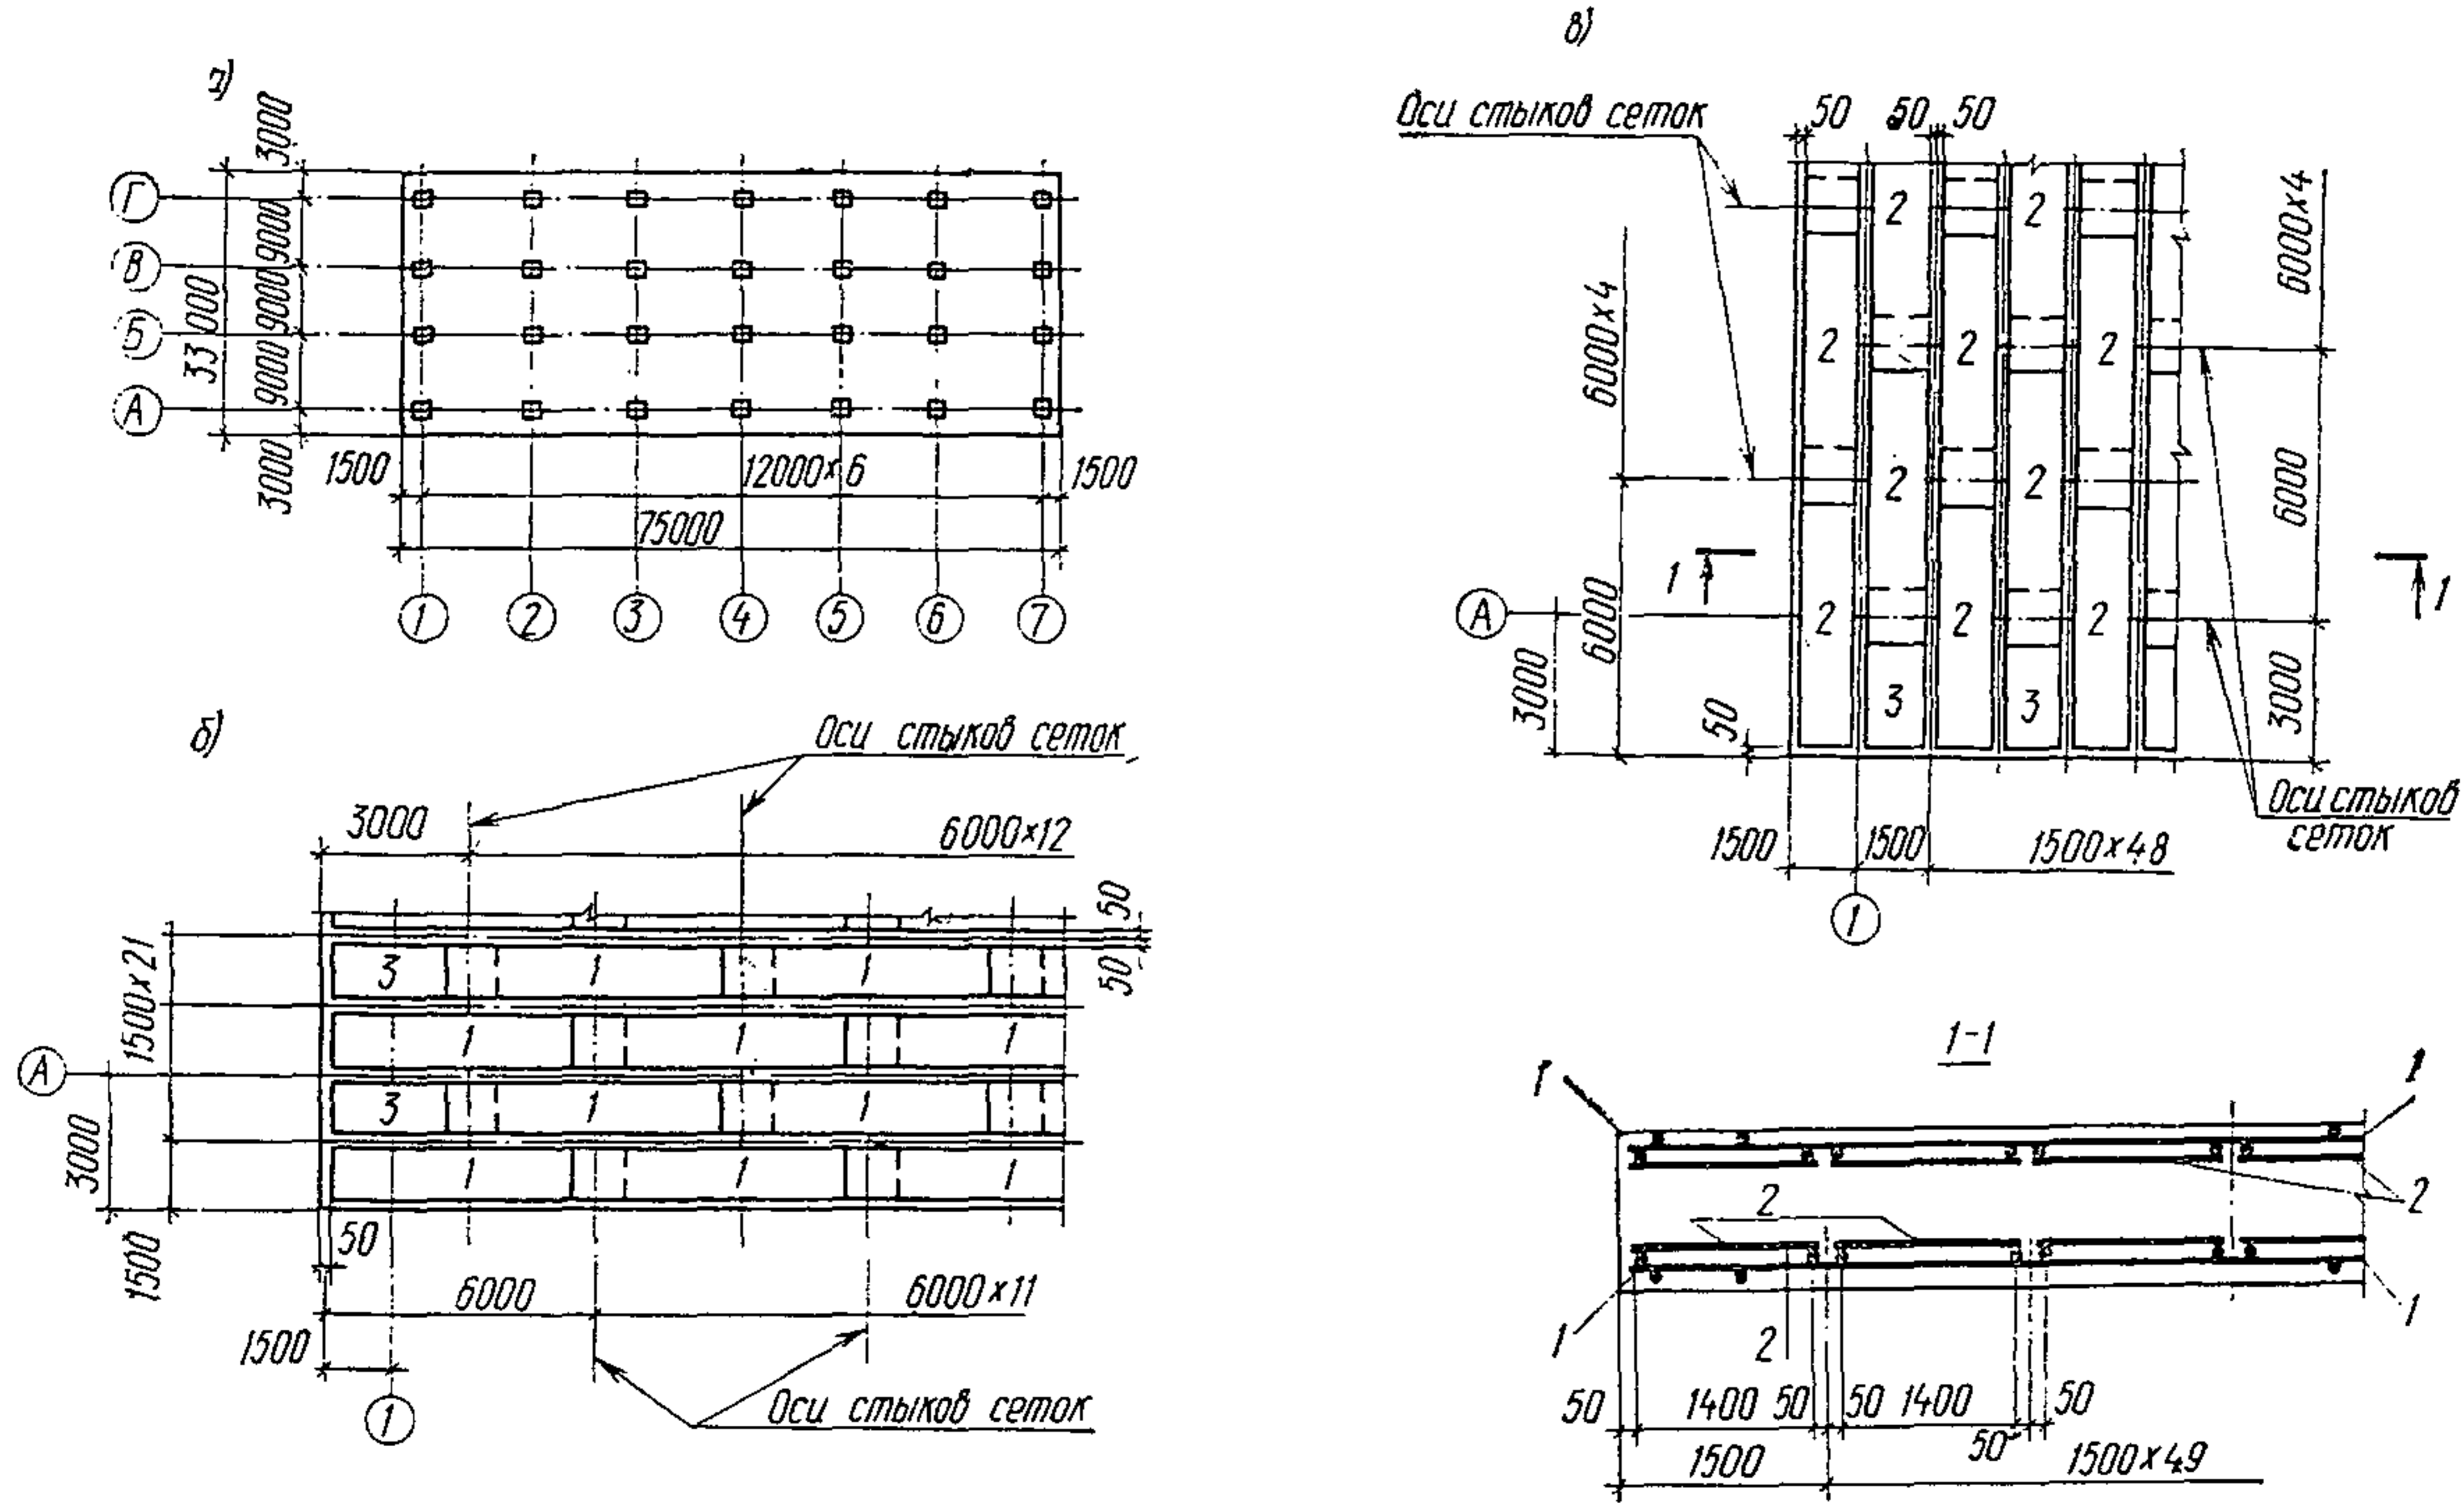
Схема раскладки унифицированных сеток армирования прямоугольной плиты
